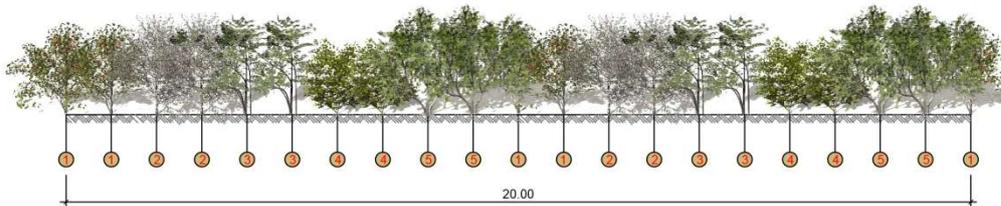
Prospetto piantagione perimetrazione bacini PI-PB
